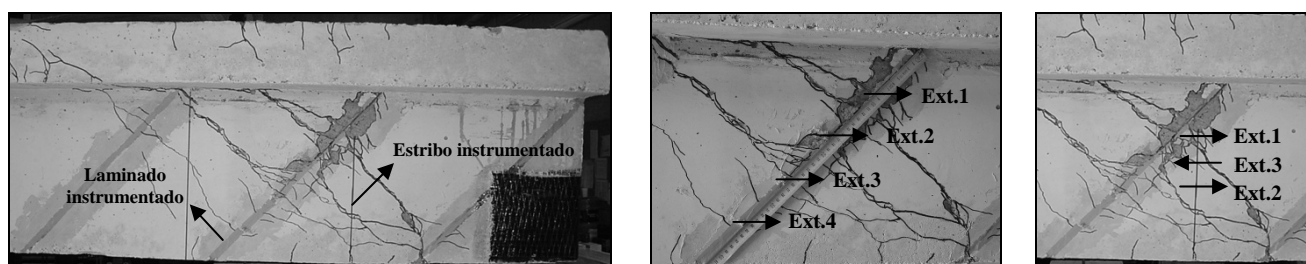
Localização dos extensômetros no laminado e estribo instrumentados da viga 2S-3LI45-A.
